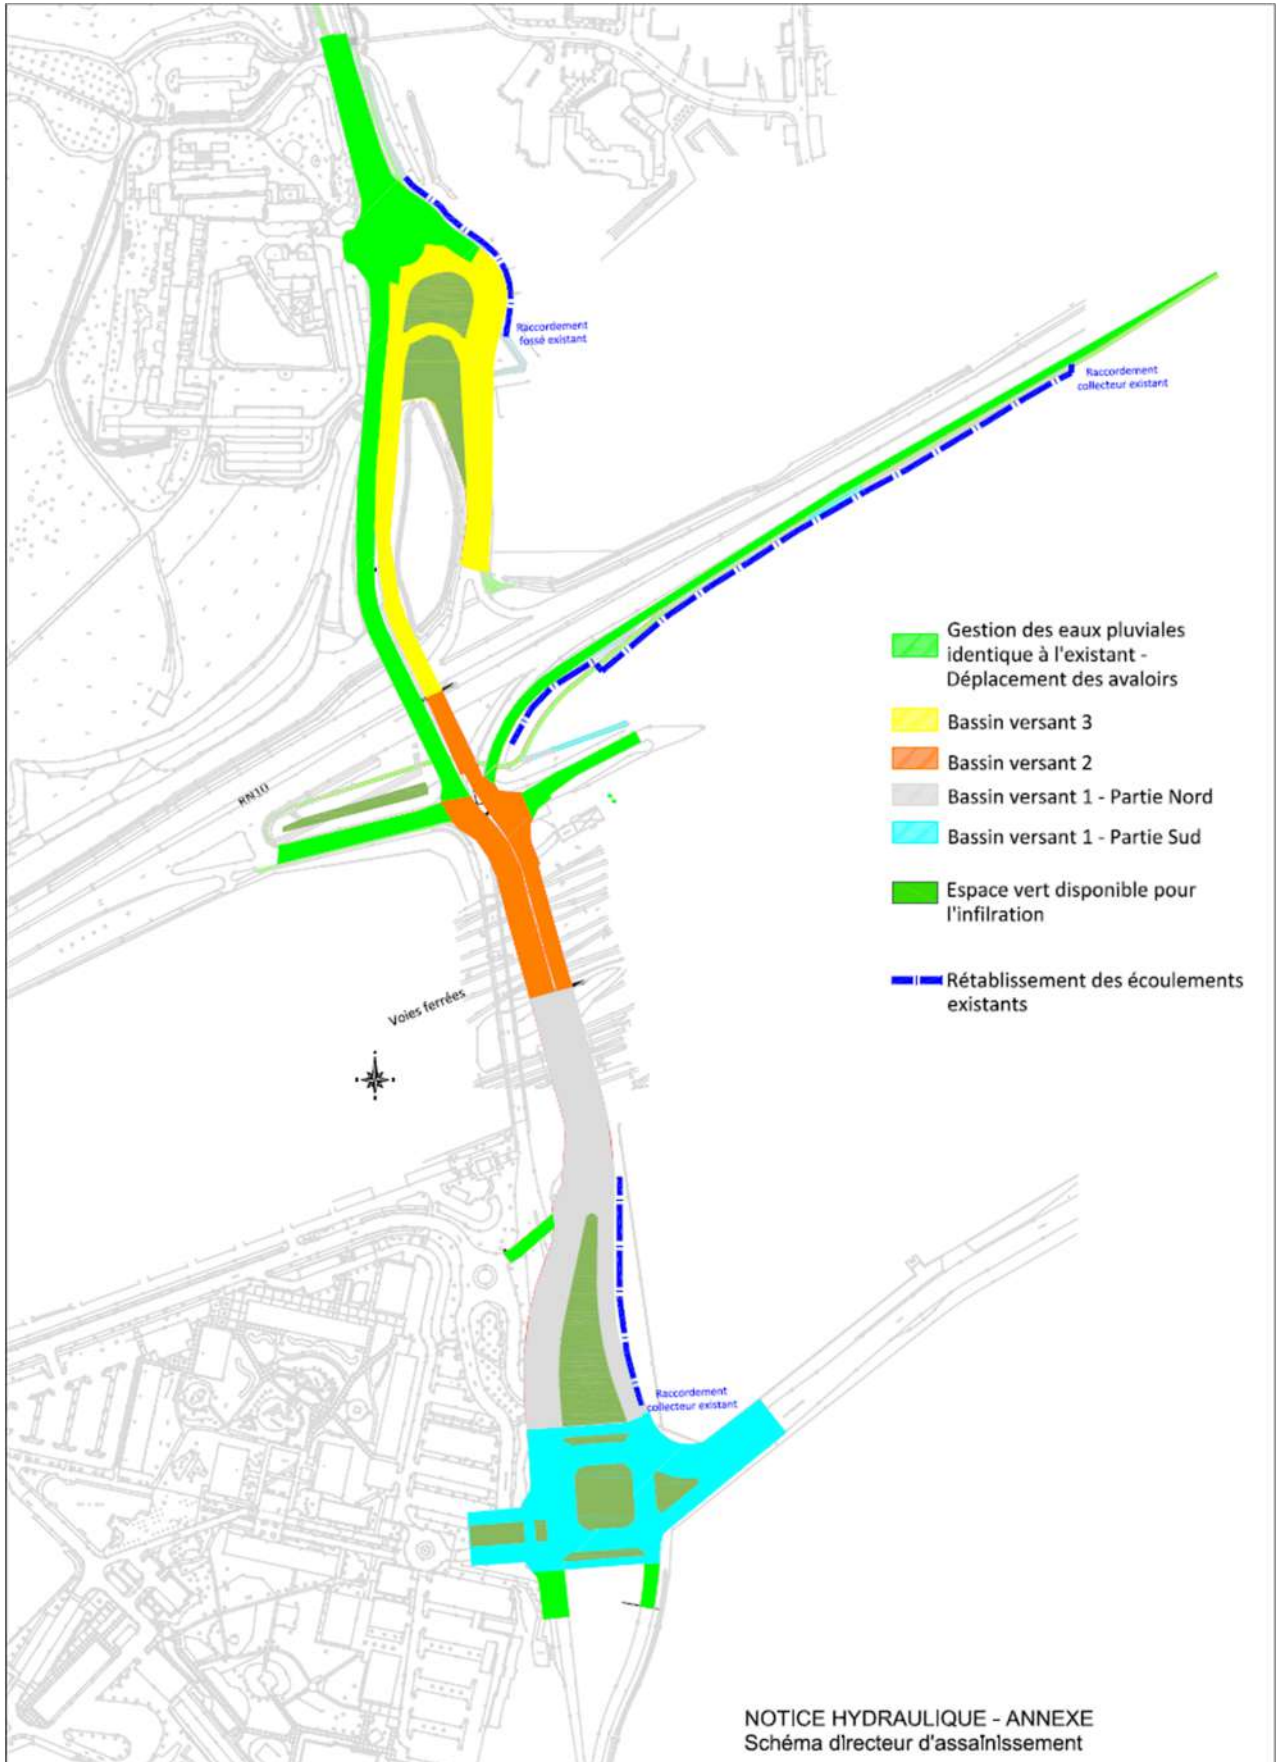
Schéma directeur pluvial – Plan des bassins versants (source : Ingérop)
